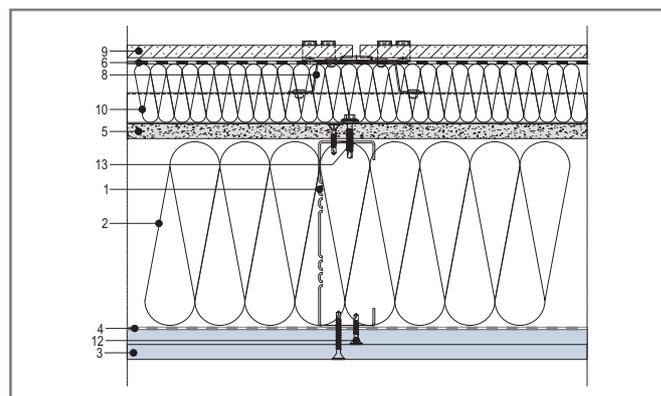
Тип № 4. Схема конструктивного исполнения наружной несущей КОС с зазором и дополнительным наружным утеплением (расшифровку цифровых обозначений см. на рис. 2)
